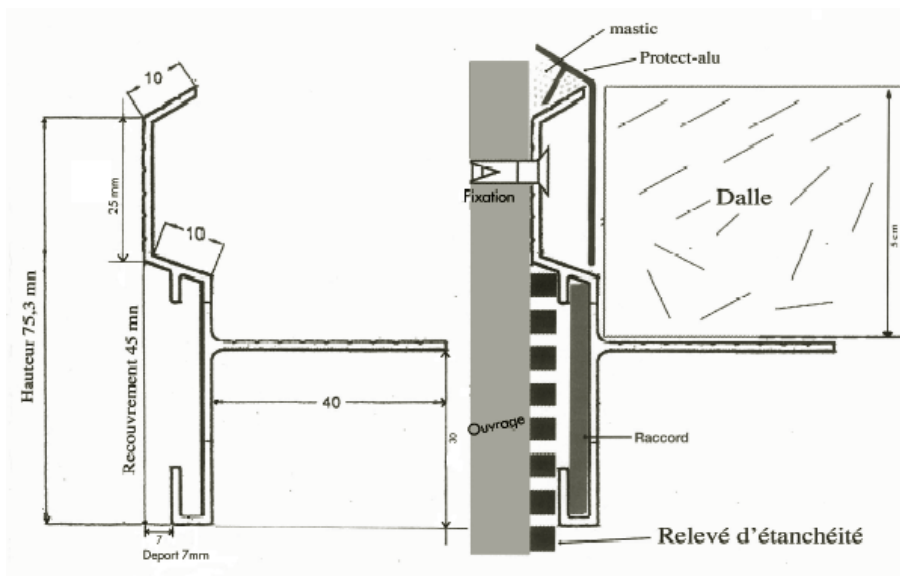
Coupe de principe avec le Solin Porte-dalles
